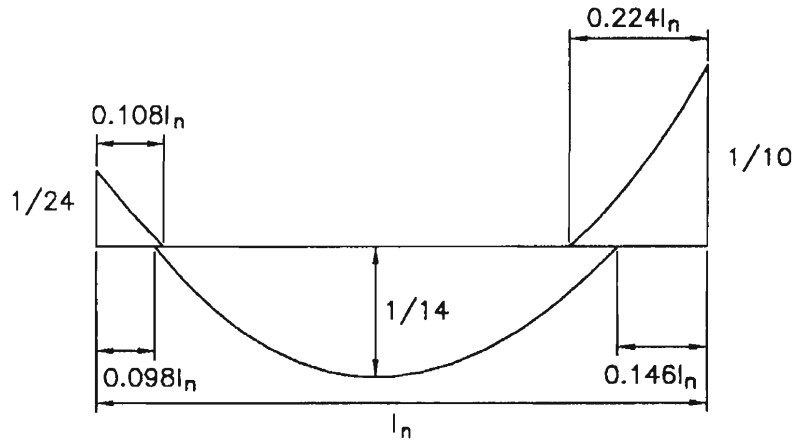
Corte del refuerzo en tramo exterior de elemento continuo con apoyo exterior solidario provisto por viga
